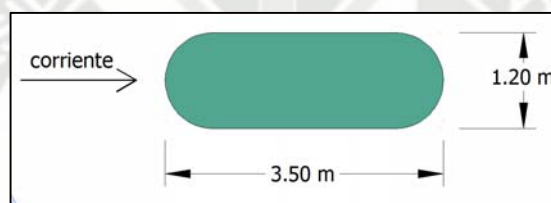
10, Sección de Pila puente “Rica Playa”^{PA}
